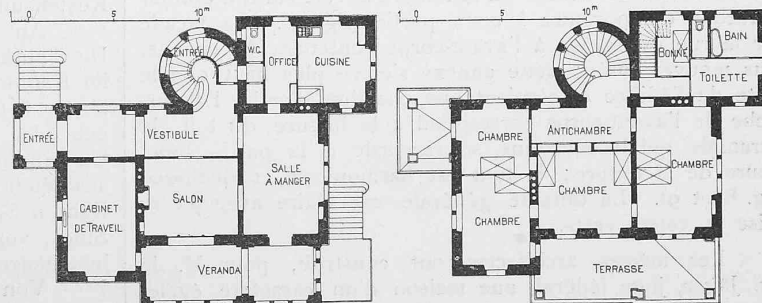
et 2. Plans du rez-de-chaussée et du premier étage de la villa Diserens au Signal. — Echelle 1 : 400.
